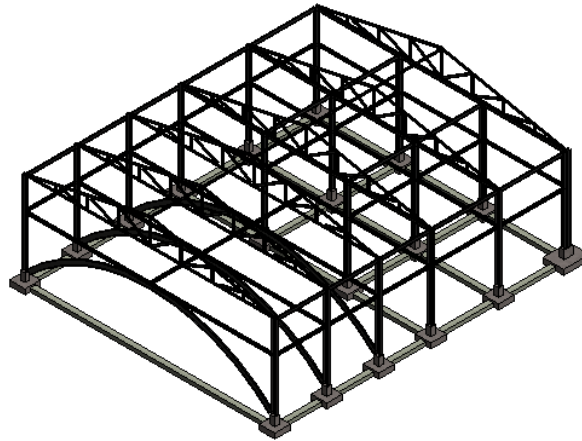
Cubierta de la zona de oficinas tras incluir viga de atado en cumbrera. Fuente: elaboración propia.
